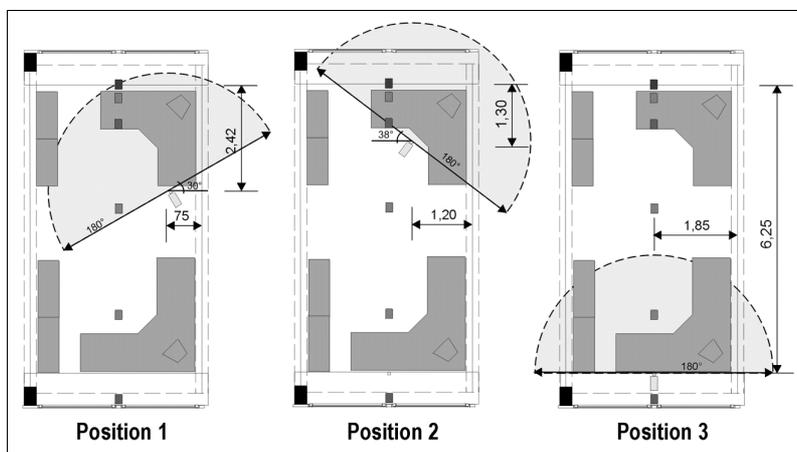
Anordnung der Leuchtdichte positionen im Grundriss
